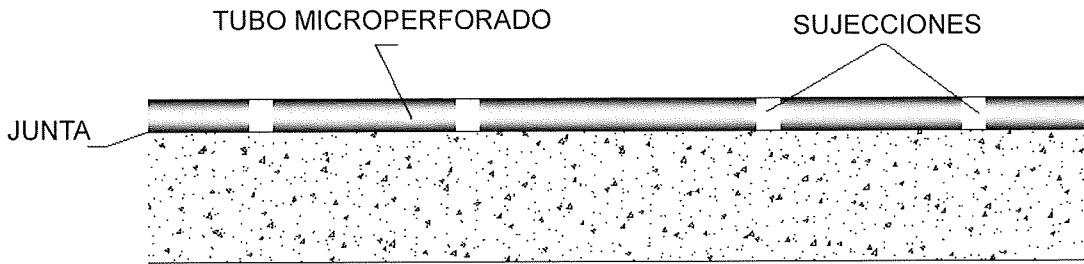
Sistema de sellado de juntas mediante tubo de inyección.
